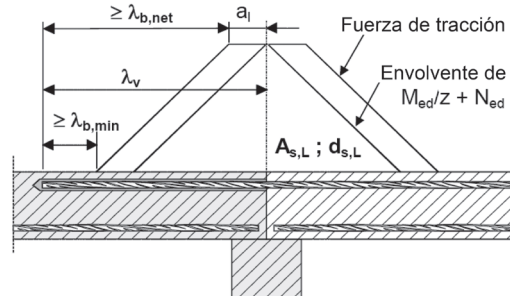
Anclaje de refuerzo para cubrir la línea de actuación de la fuerza de tracción.
